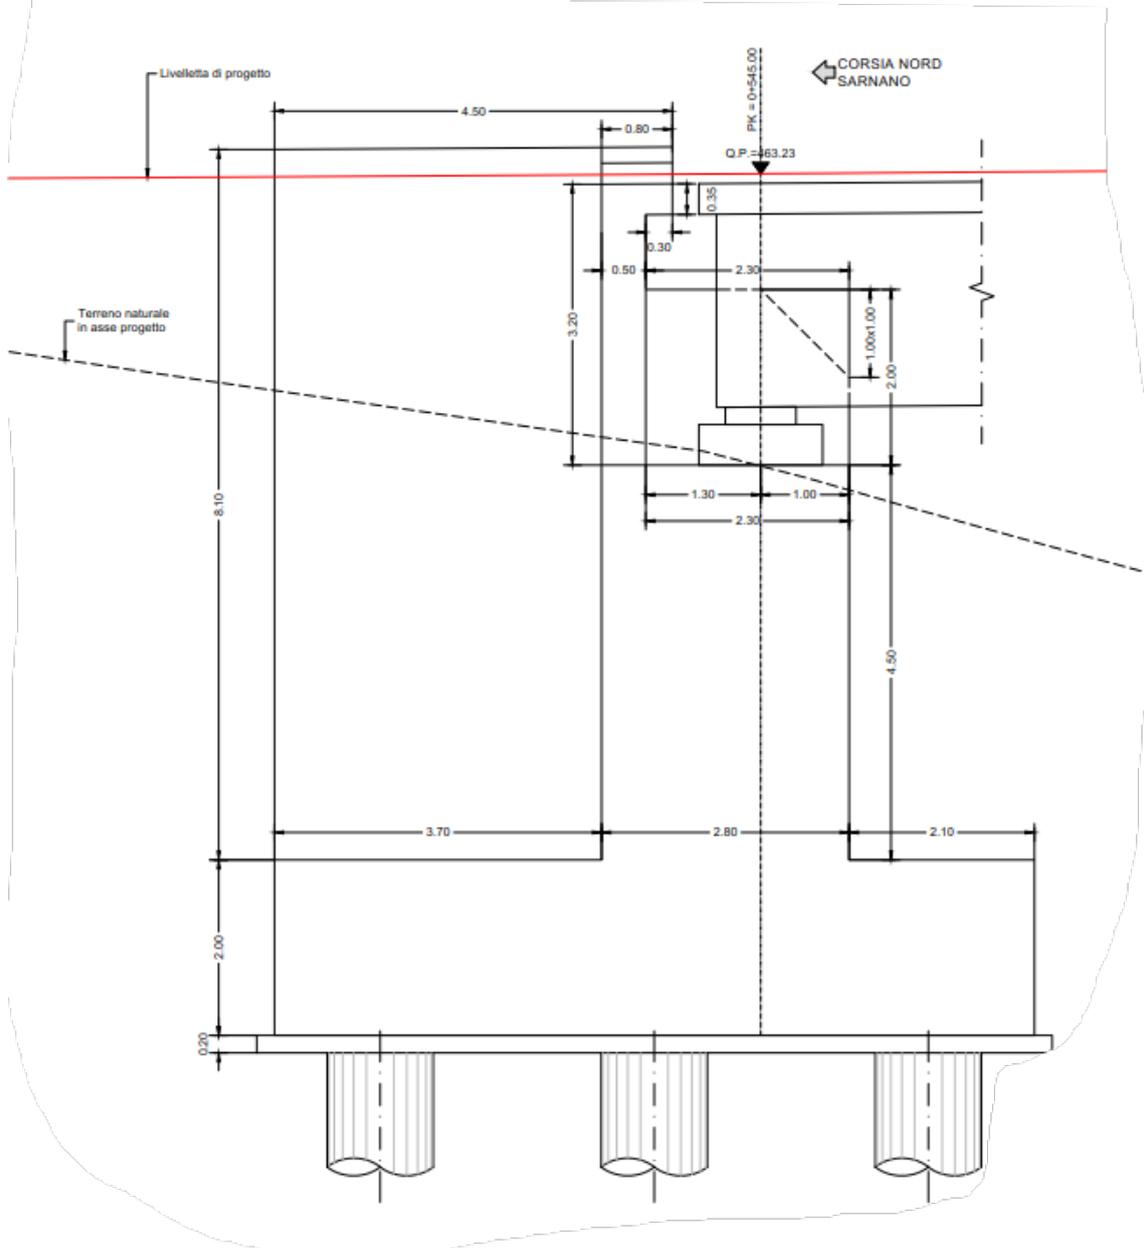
Sezione trasversale spalla A lato Sarnano
